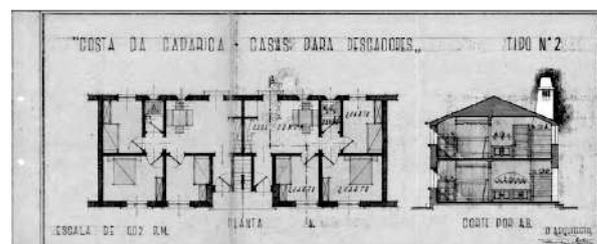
Bairro de Casas para pescadores de Costa da Caparica — Alçado principal e corte transversal.
